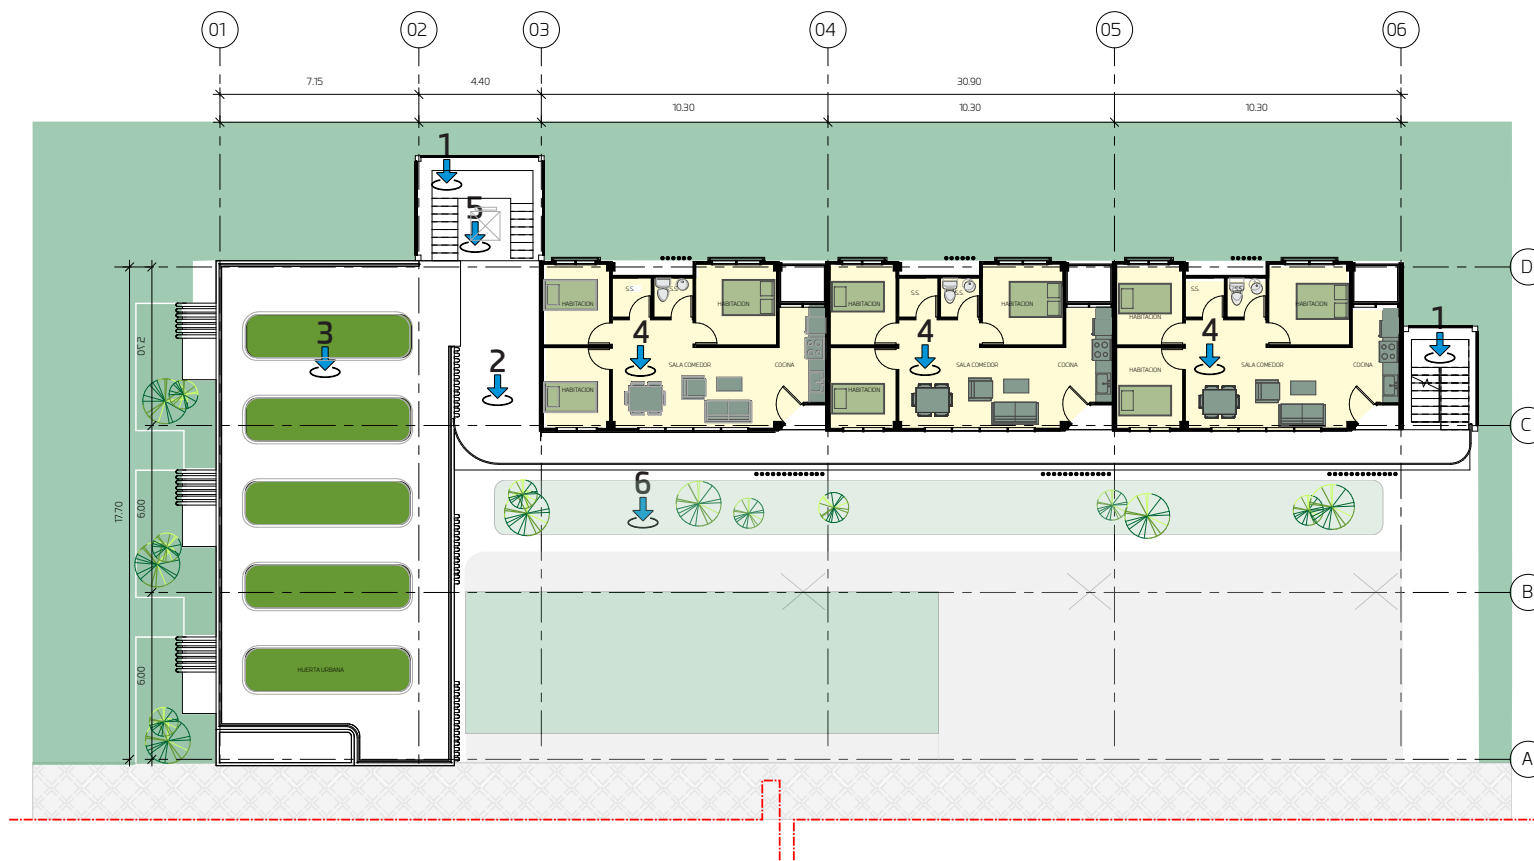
Planta de distribución general de tercer nivel por módulo
